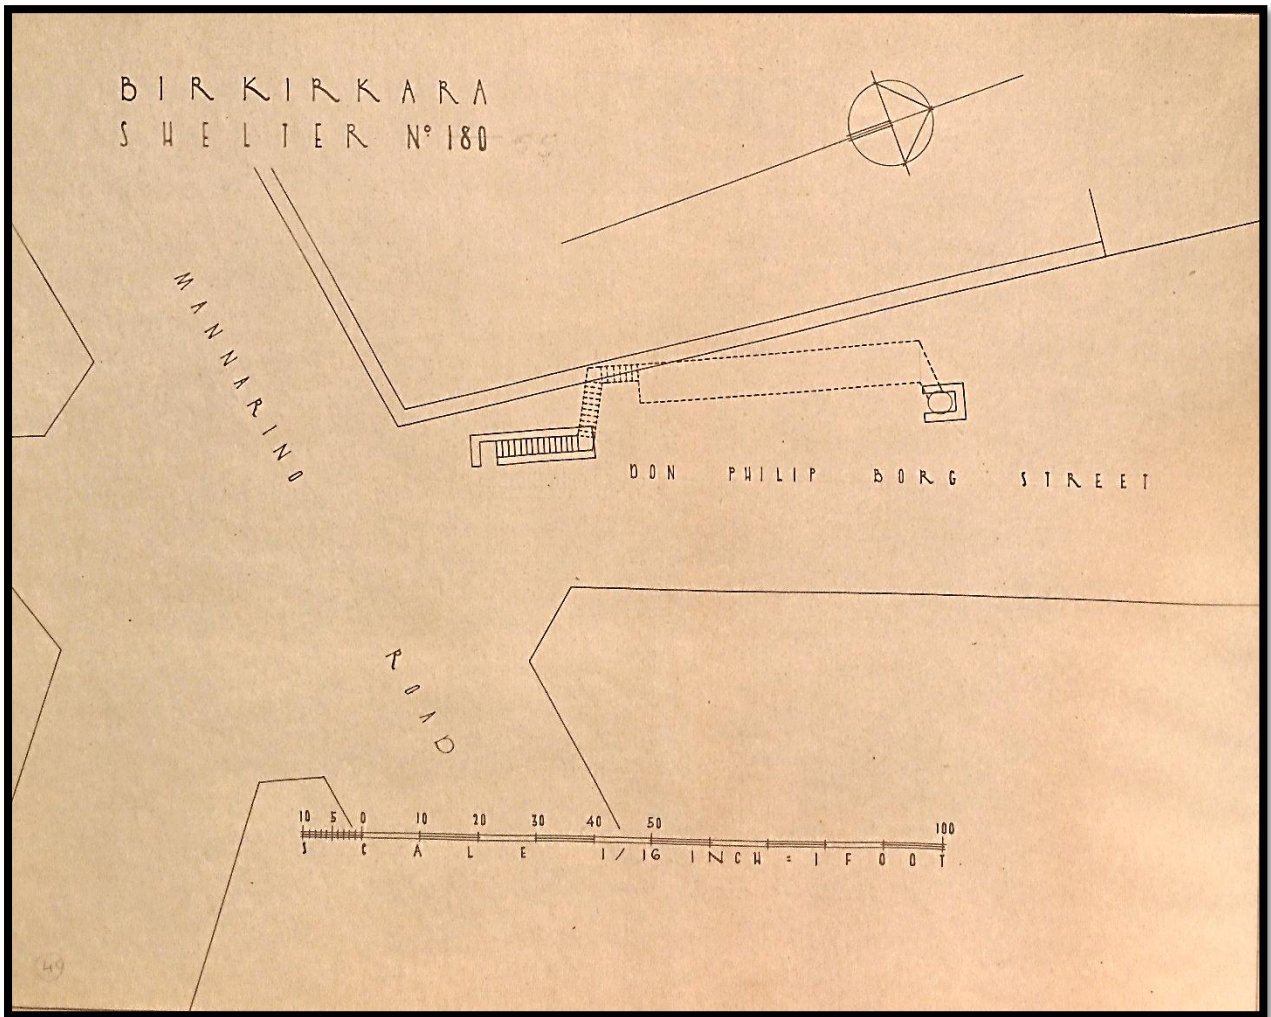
Planta do Abrigo nº 180 (55) "Mannarino Road – DON Philip Borg Street."
